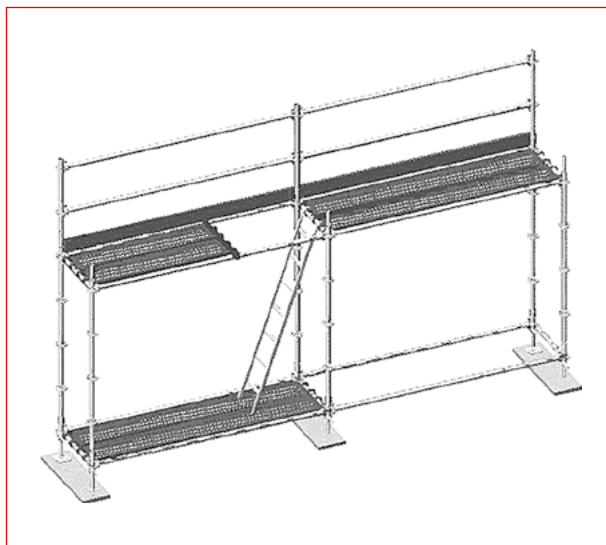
Вход на леса с использованием стальной межуровневой лестницы и ригеля внахлест
